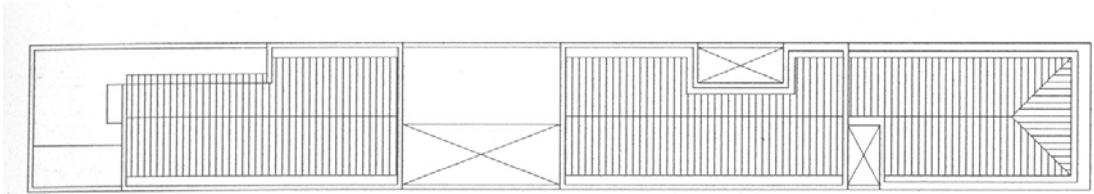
Rua do Livramento 147 – Planta de cobertura (SECRETARIA, 2000, p. 53).
